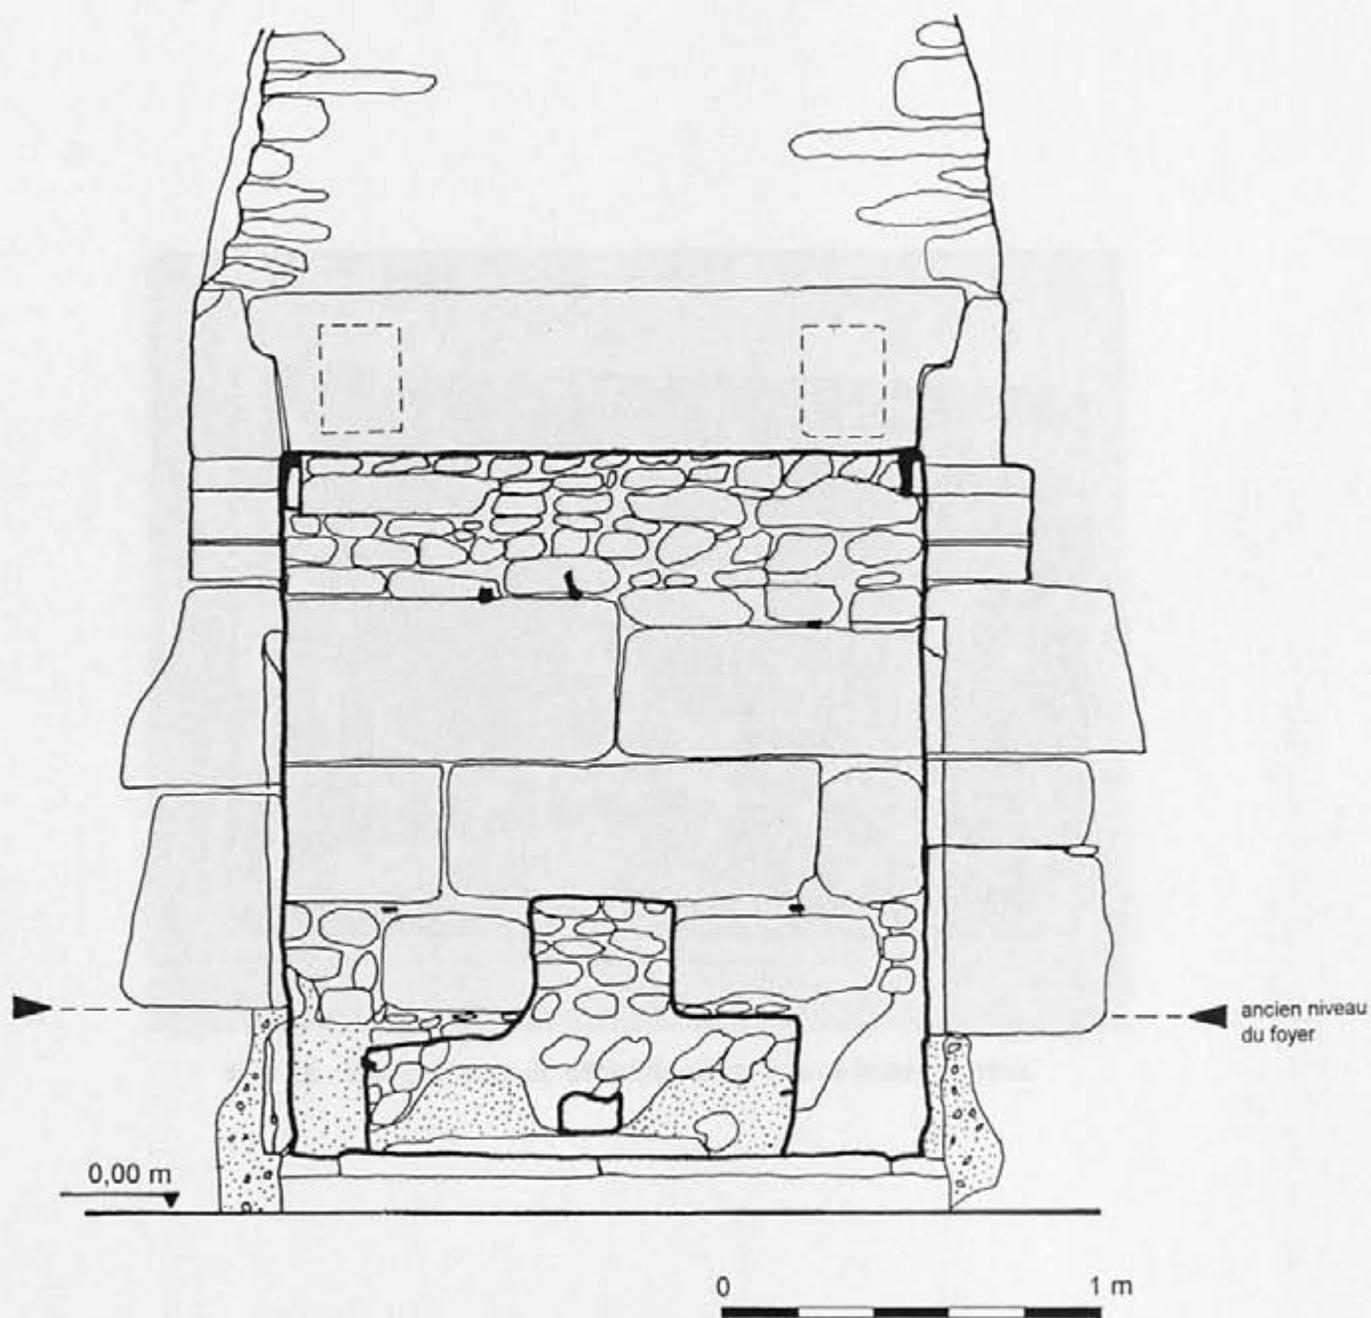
Cheminée 1 s'ouvrant dans le mur 2, avant piquetage et enlèvement des placages
